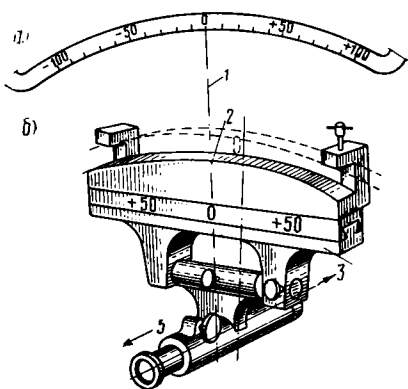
Щитовой оптический прибор для ведения геодезических работ: а — схема визирной дуги; б — устройство на щите оптической трубы; 1 — вертикальная ось щита; 2 — риска; 3 — створ сигналов; 4 — салазки для поперечного перемещения трубы; 5 — направление проходки
